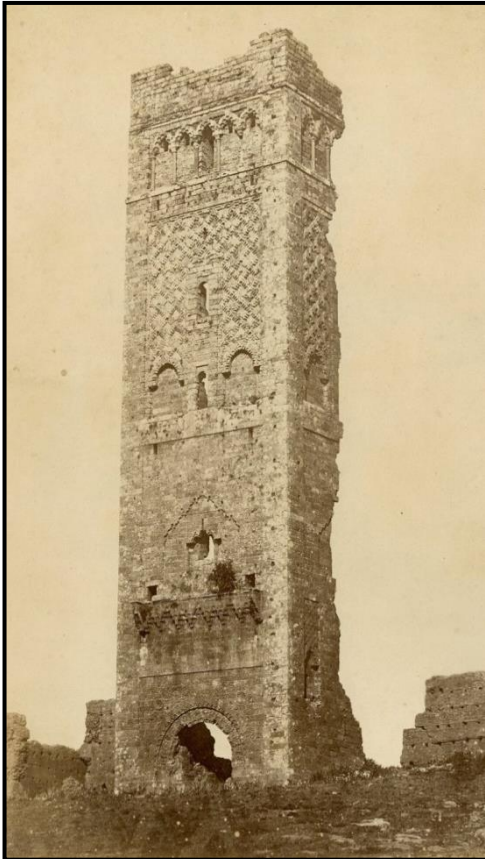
MINARET AVANT RESTAURATION DE 1877, ELEVATION NORD
